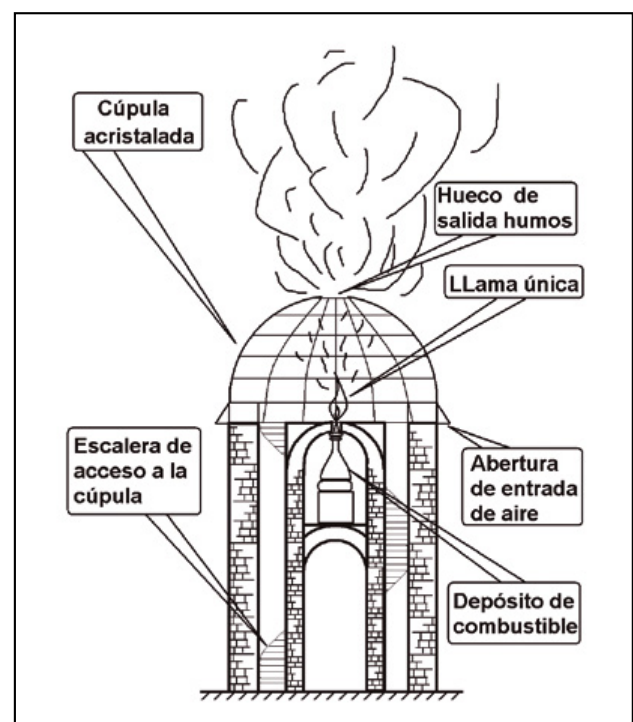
Hipotética estructura interior de la luminaria del faro de Alejandría. Elaboración propia.
